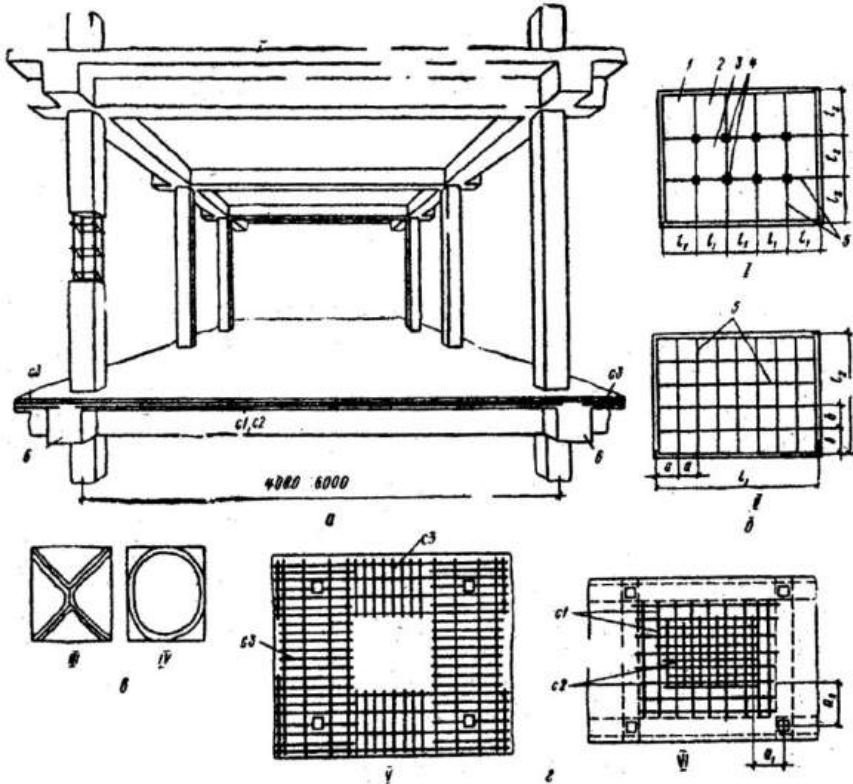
Монолітне ребристе перекриття з плитами, які працюють у двох напрямках: а – загальний вигляд; б – плани перекриттів; в – схеми руйнування плит; г – схеми армування плит; І – ребристе перекриття; ІІ – кесонне перекриття; ІІІ – тріщини на нижній поверхні; ІV – тріщини по верху плит; V – верхня опорна арматура; VI – нижня прольотна арматура; І – кутова панель; 2 – перша панель; 3 – середня панель; 4 – колони; 5 – контурні, балки; б – арматуру умовно не показано
